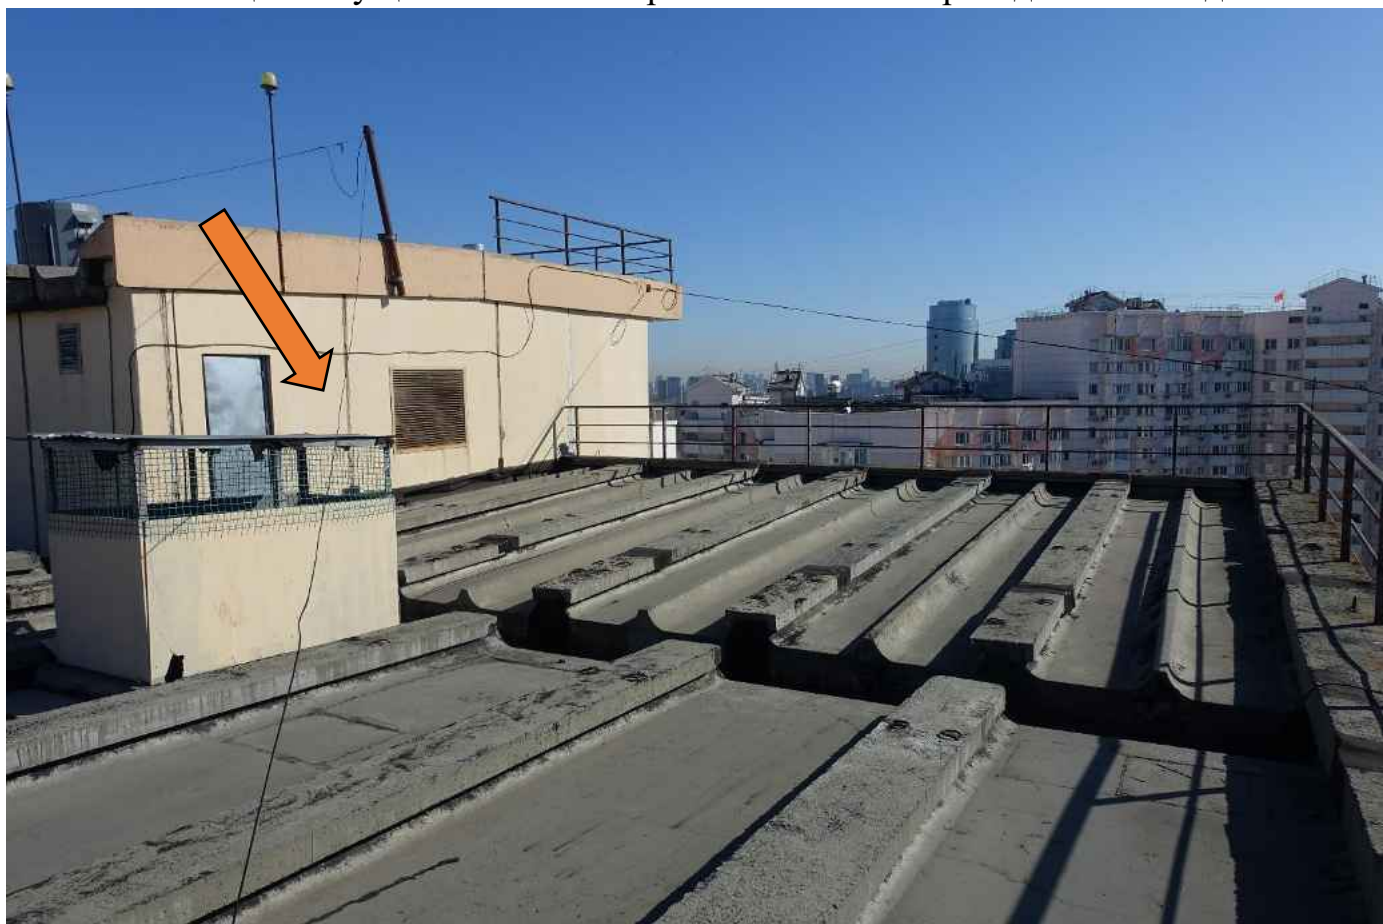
Локальные участки кровли защищены гидроизоляцией.
